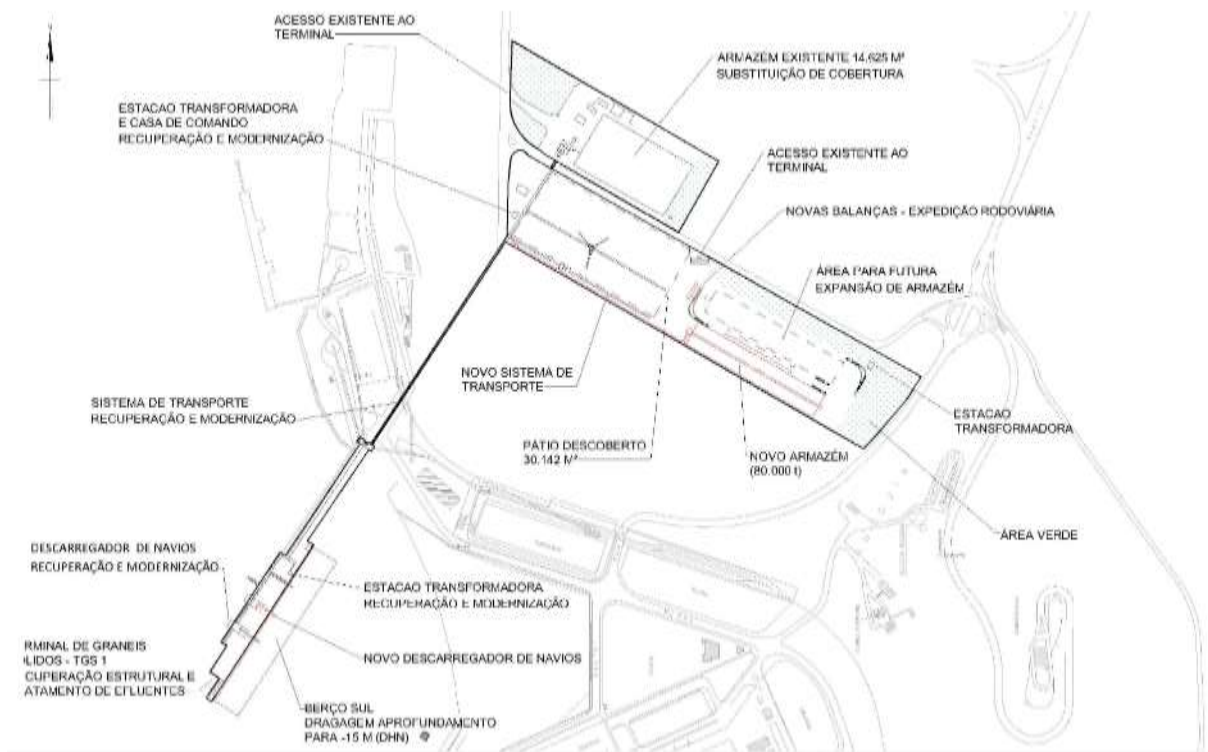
Layout e intervenções ATU12 Fonte: ANTAQ
